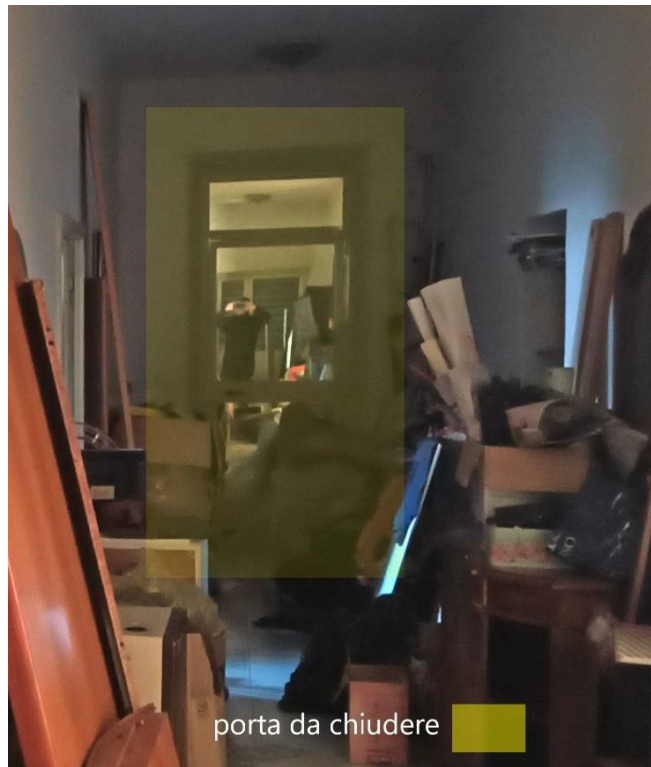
ubicazione porta piano terra da chiudere (foto da sopralluogo del 12/01/2024)
